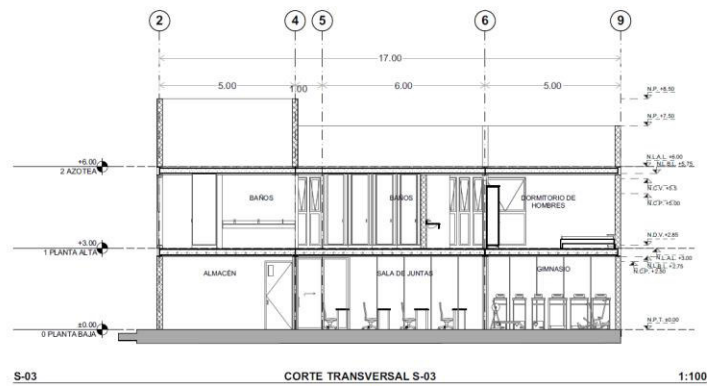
Corte transversal S-03. Anteproyecto. Fuente: propia.
